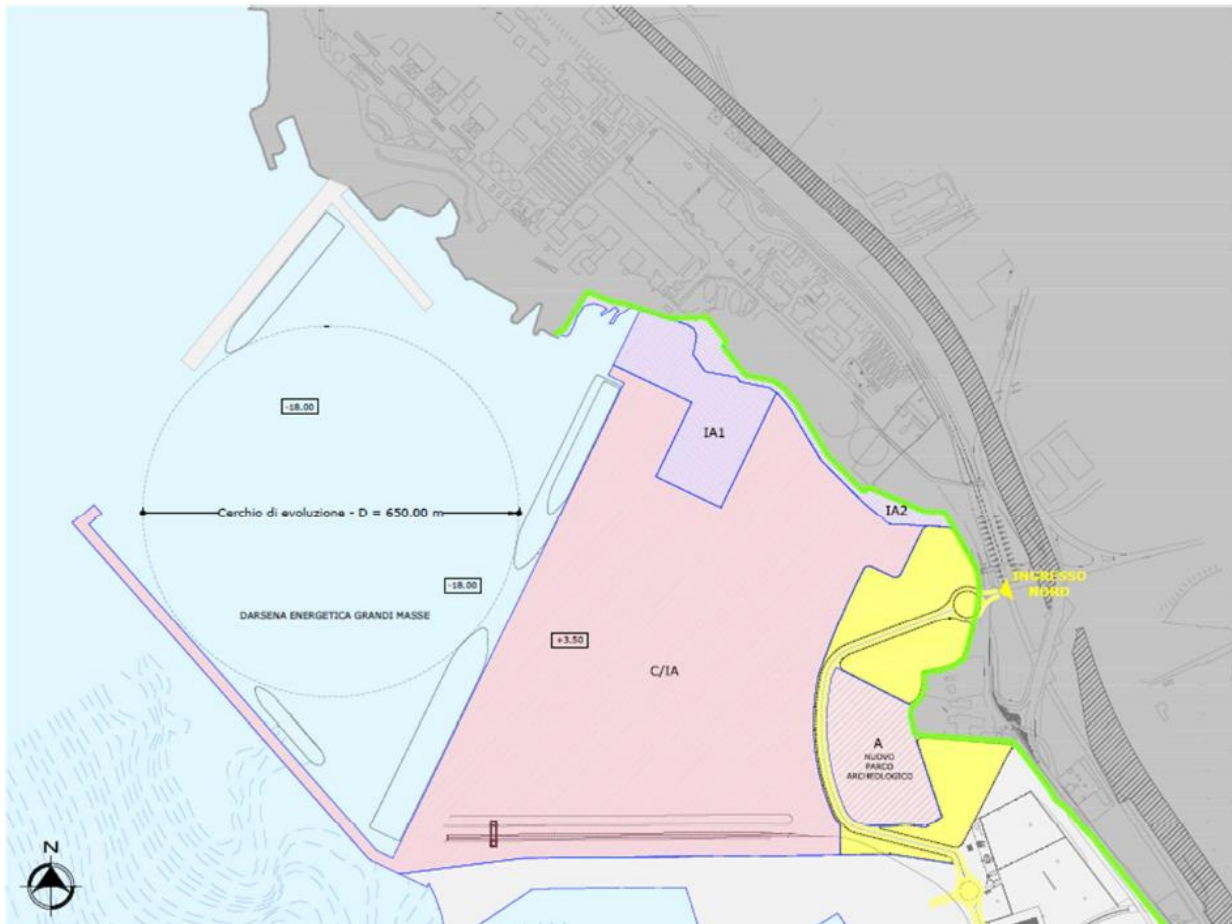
DEGM nella configurazione prevista dall’ATF 2014
